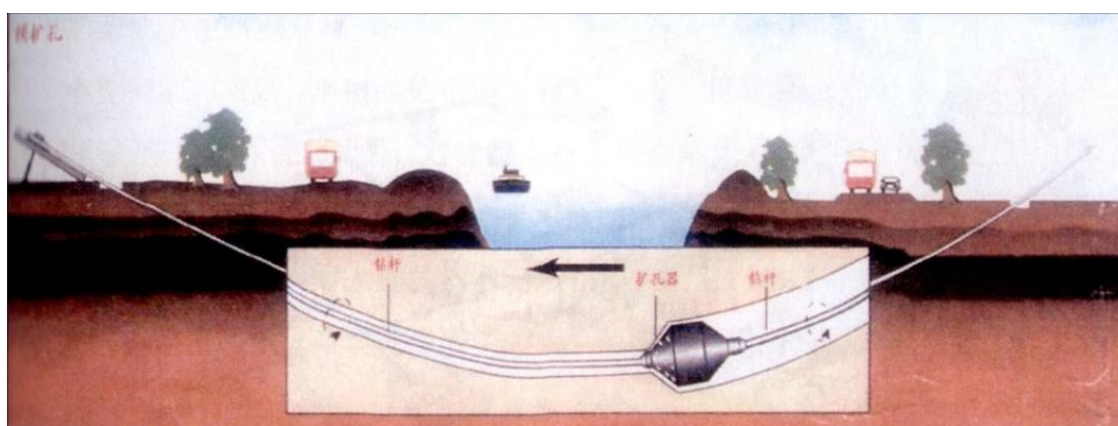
定向钻穿越施工钻预扩孔过程断面示意图
